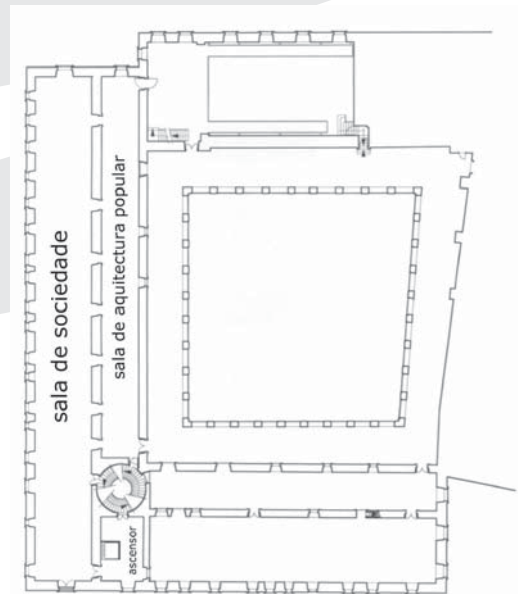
Plano da 1ª planta do convento de Bonaval e situación da nova sala da Sociedade.
